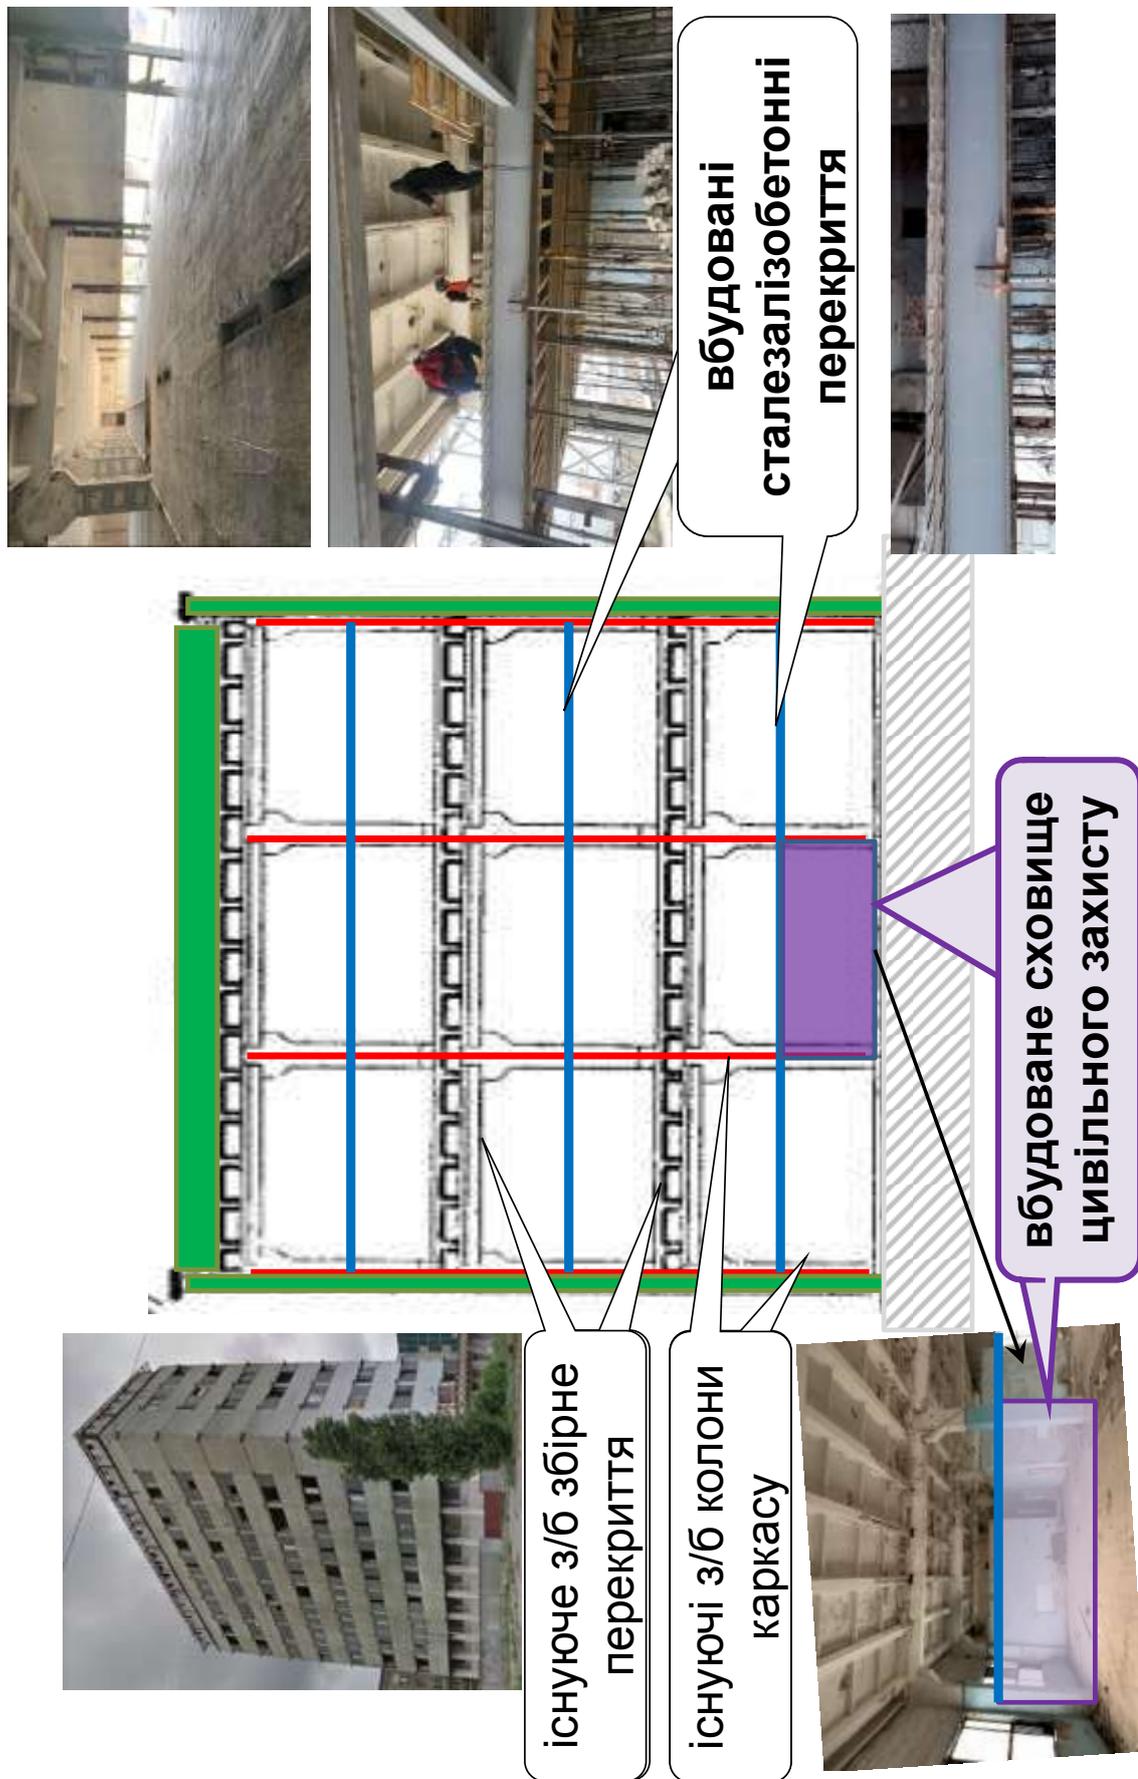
Варіант 1 влаштування вбудованих сховищ у багатоповерховій промисловій будівлі
